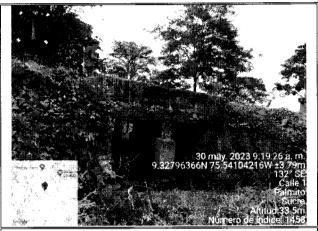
Vista de la sección transversal de la obra hidráulica tipo box colvert de 8.70 m de largo a intervenir
